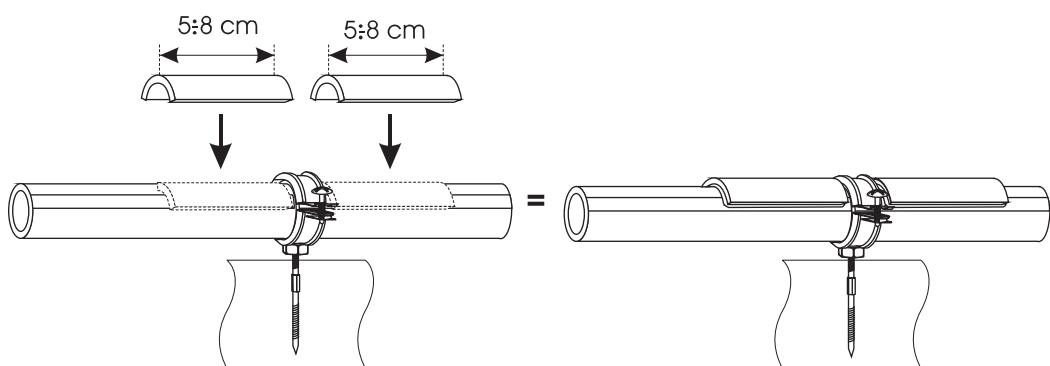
Неподвижный захват на трубе (с наклейкой накладок из той же трубы)
